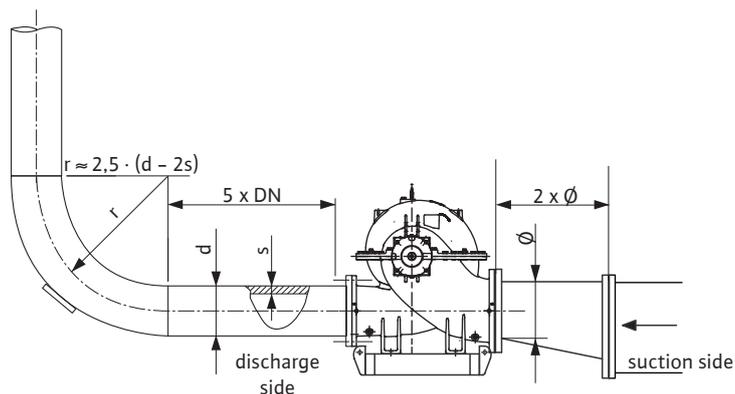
Collegamento della pompa senza tensioni meccaniche, percorso di stabilizzazione a monte e a valle della pompa
